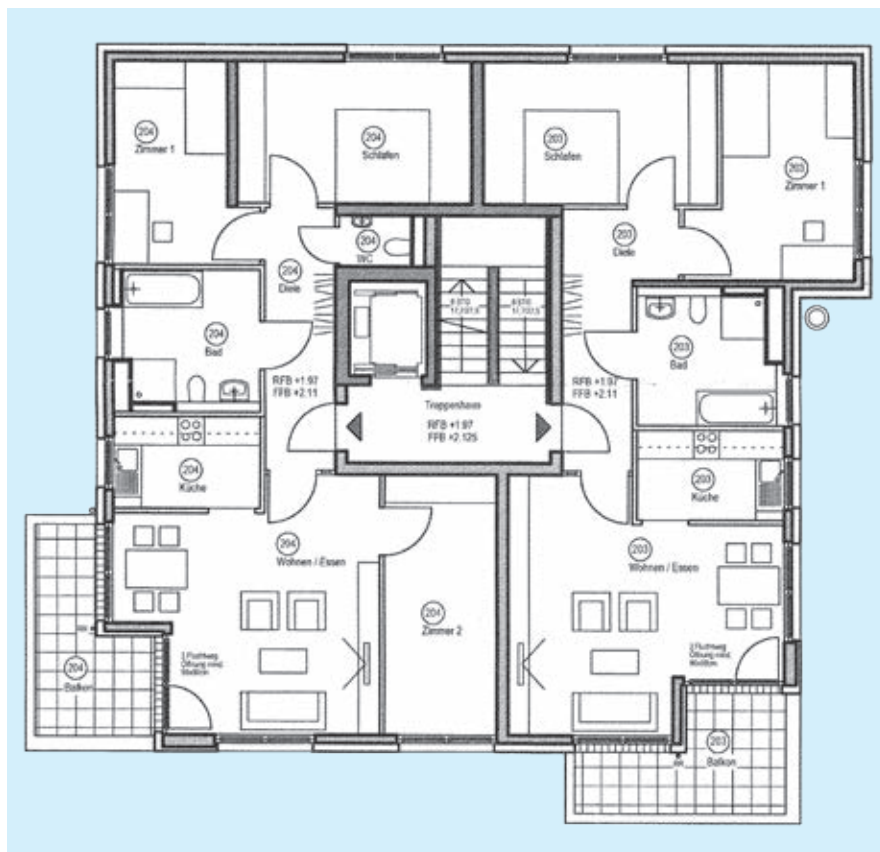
Grundrissbeispiel für das Planungskonzept des Siedlungswerks „Freiräume schaffen“
